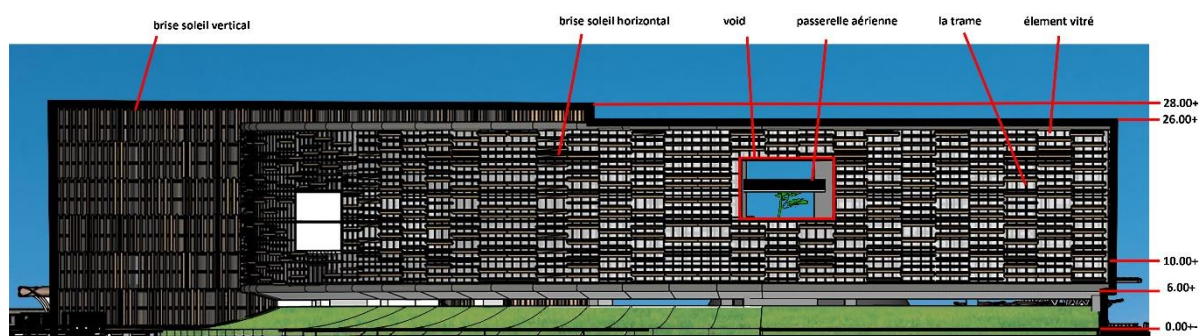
traitement de façade ; vue sur la façade sud -ouest
